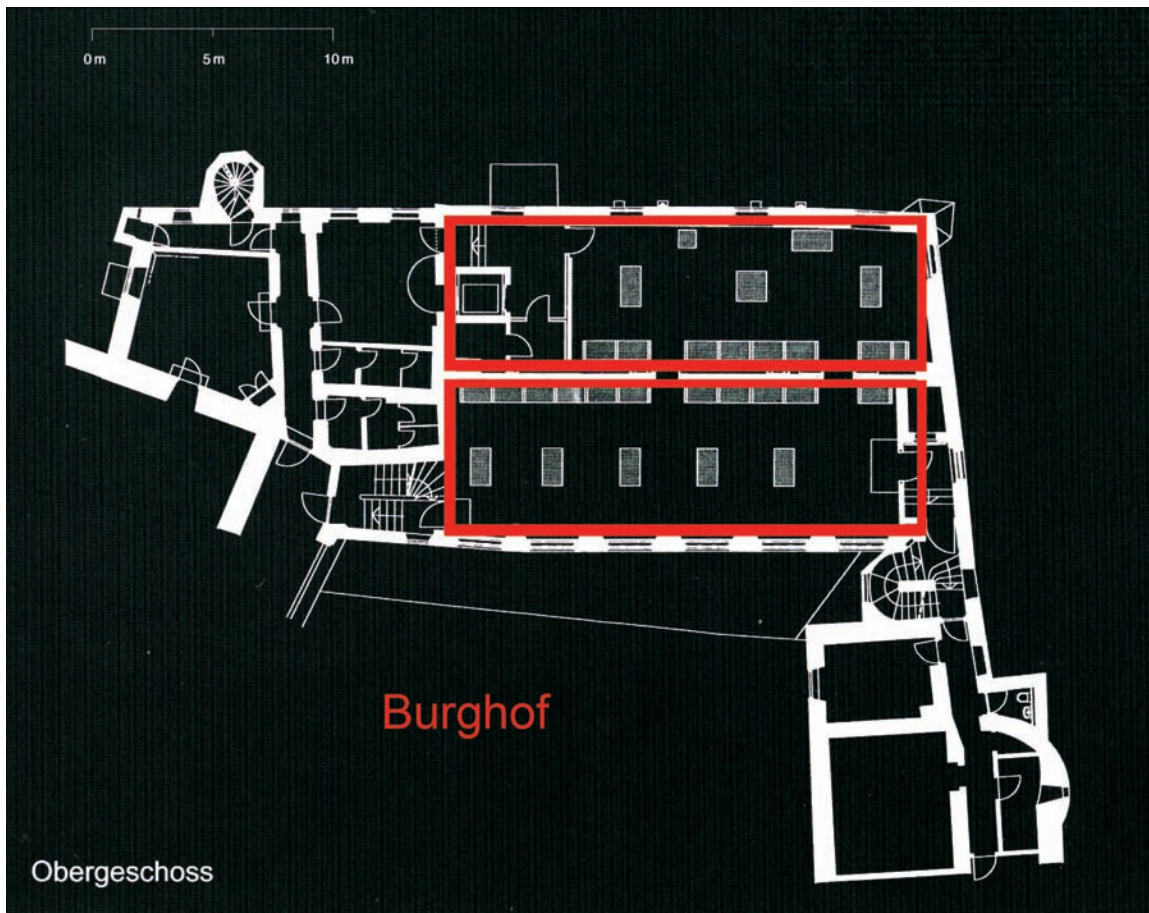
Landshut, Burg Trausnitz, Grundriss Damenstock, OG mit zwei gleich großen Ausstellungsräumen.
